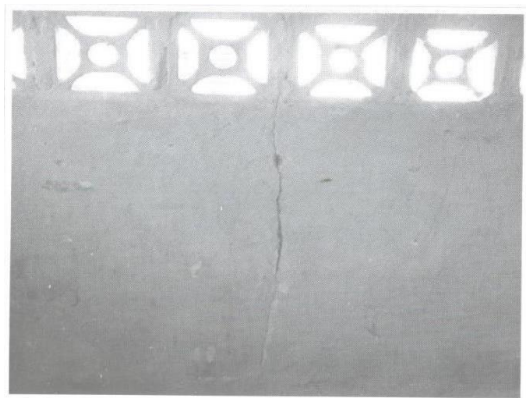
No existen columnas de confinamiento alrededor de los muros<sup>5</sup>.
